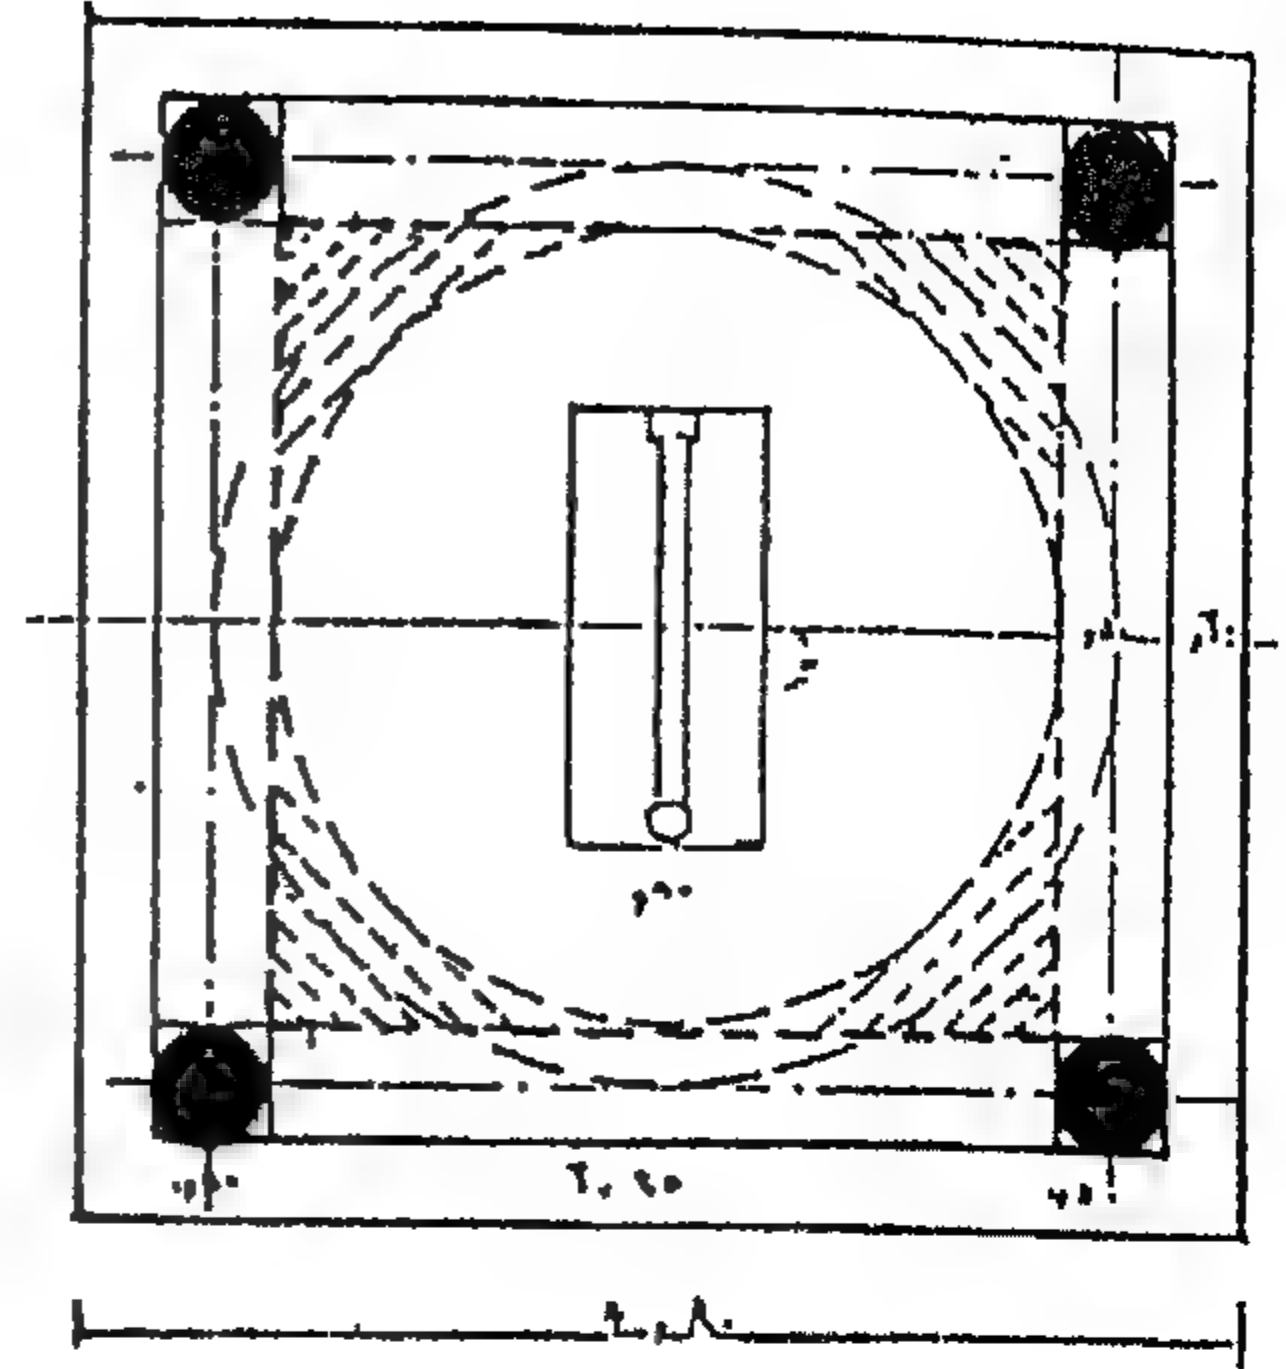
مكرر) مسقط أفقي لمدفن مصطفى أغا جالق (بقرافة السيوطي بالقاهرة).
